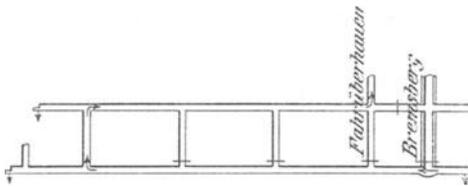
Grundstrecke mit Begleitort und Durchhieben.
